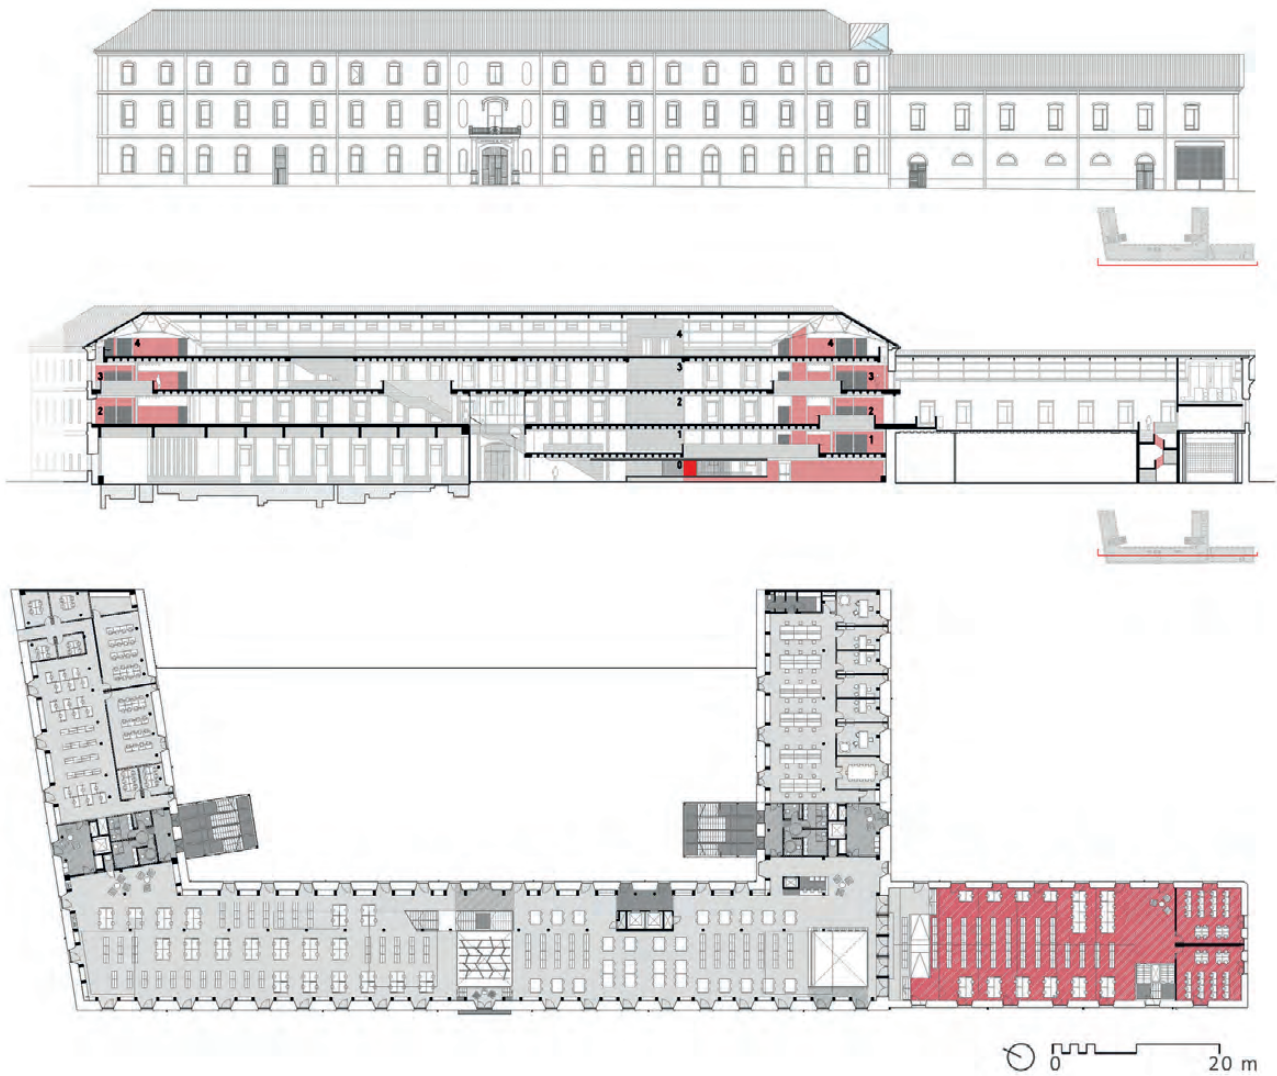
Planta, alzado y sección longitudinal del CRAI. CDE Arquitectura / Figure 5. LCR plans, section and elevation. CDE Arquitectura.
